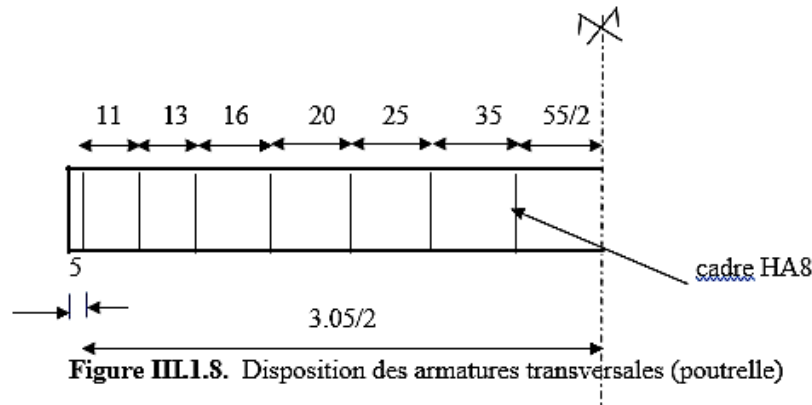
Disposition des armatures transversales (poutrelle)
